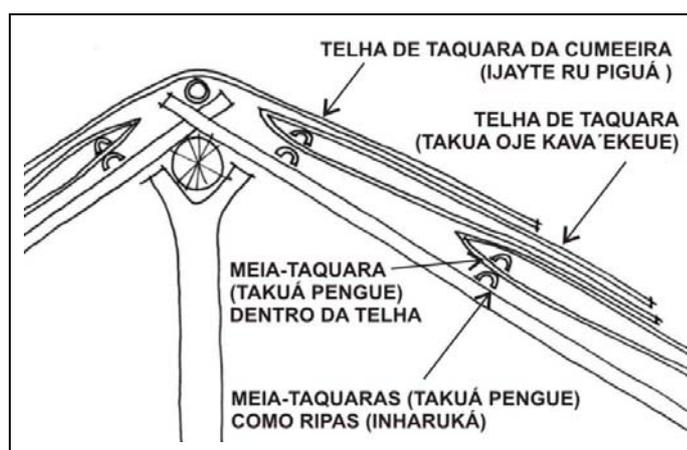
croqui esquemático dos elementos construtivos da cobertura.
